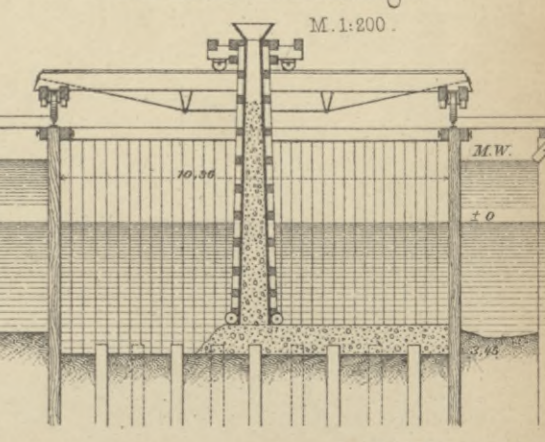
Gerüst mit hölzernem Trichter zur Betonversenkung.
